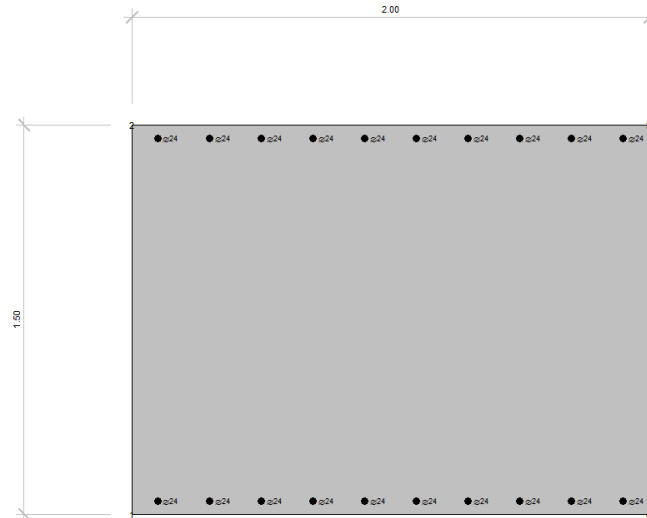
Platea di fondazione sotto al risvolto destro – Schematizzazione a elementi frame
